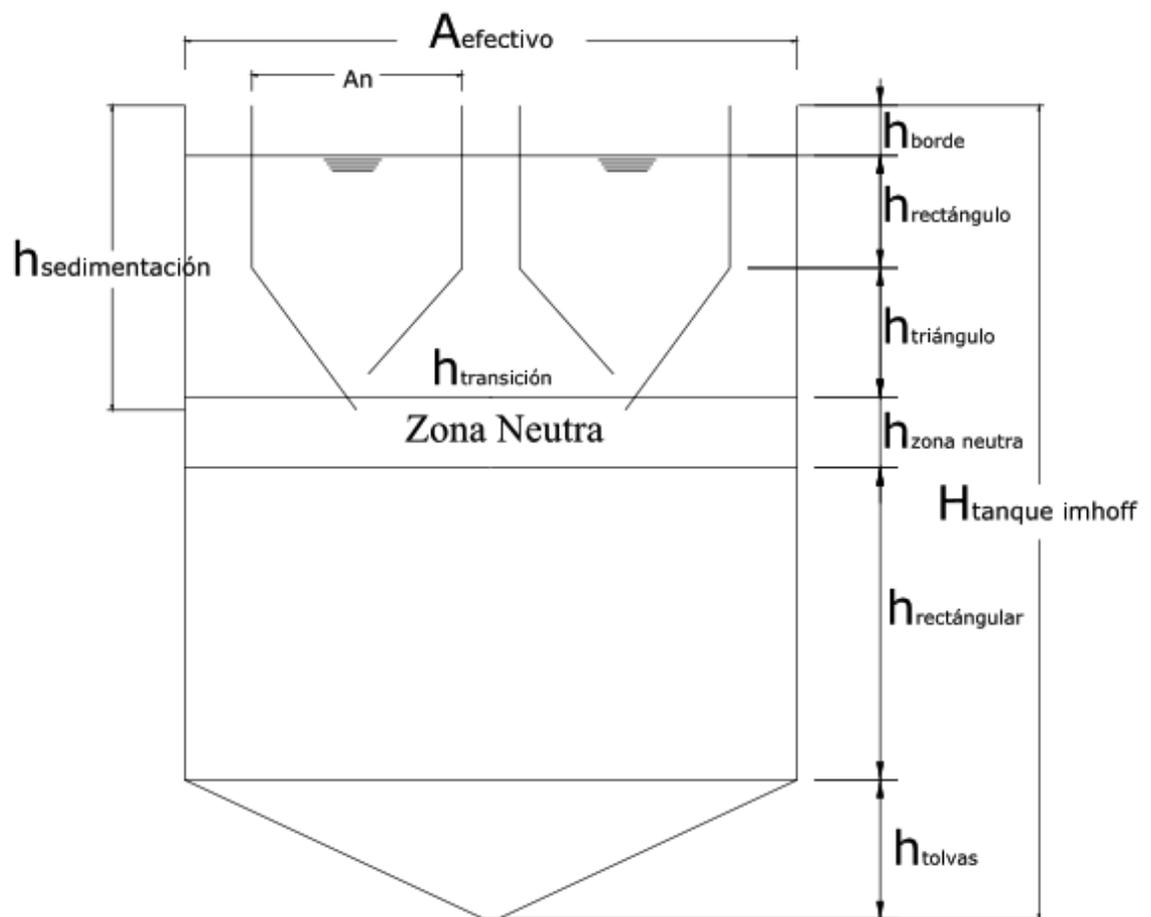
14 esquema de dimensiones de Tanque Imhoff
